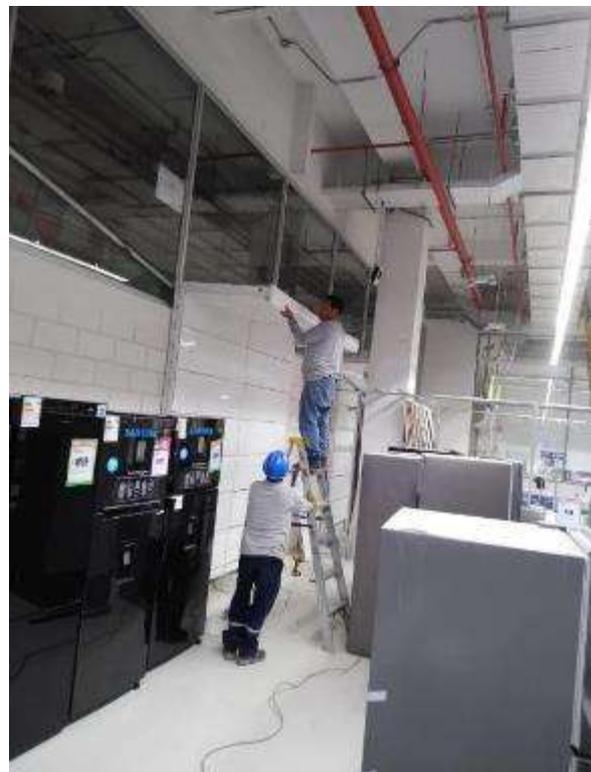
FOTO OBRA - Instalación tubería y cajas de pase IIEE
